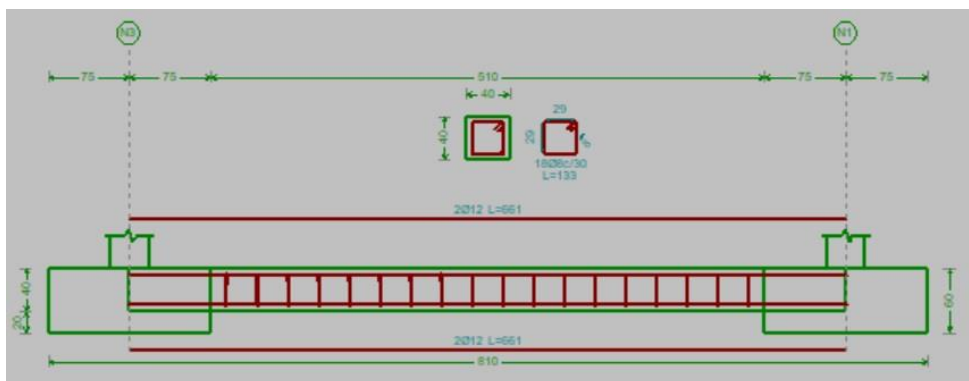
Alzado de la viga de atado analizada. Fuente: CYPE 3D.
